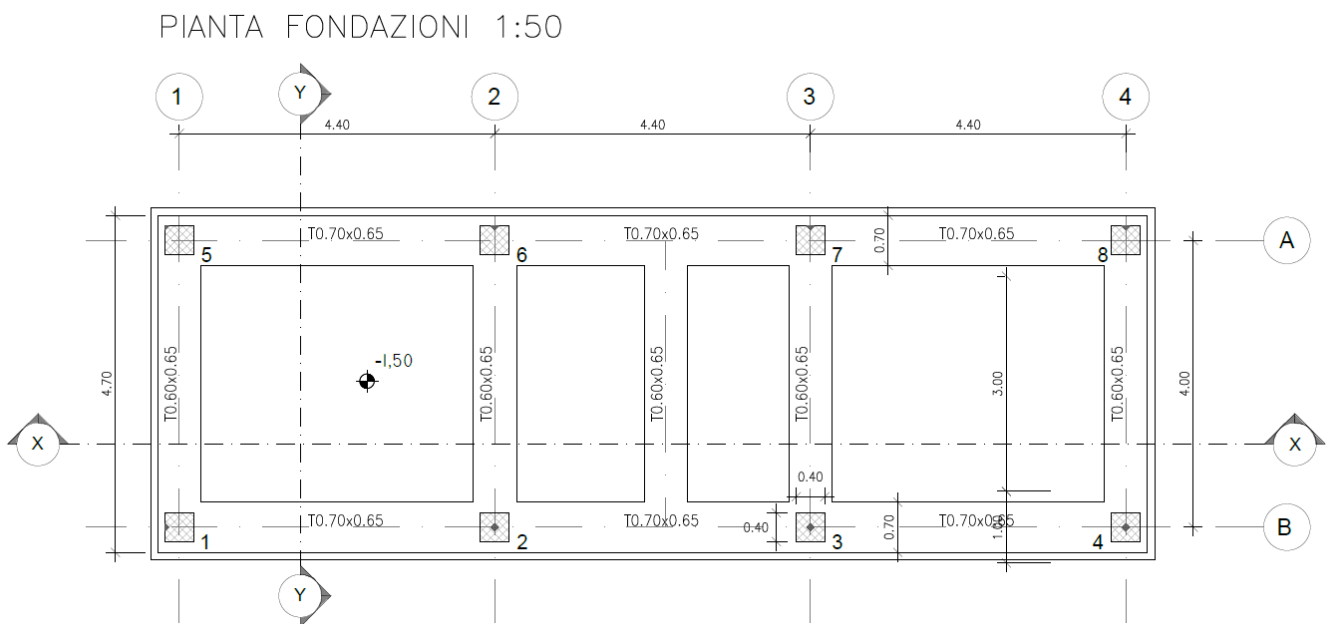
Esempio di pianta fondazioni per strutture come quella in progetto
